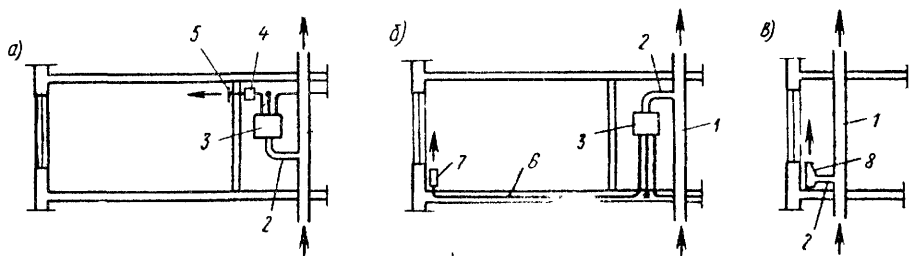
Комбинированное воздушное отопление зданий с централизованной подачей подогретого воздуха по воздуховоду и местным нагреванием
